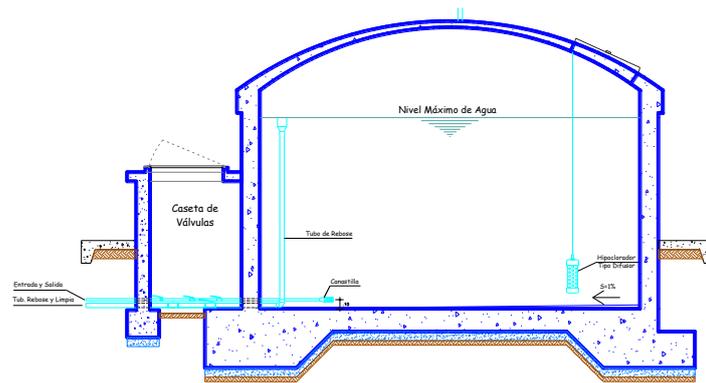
Vista en Corte - Reservorio apoyado circular proyectado (Elaboración: propia)
